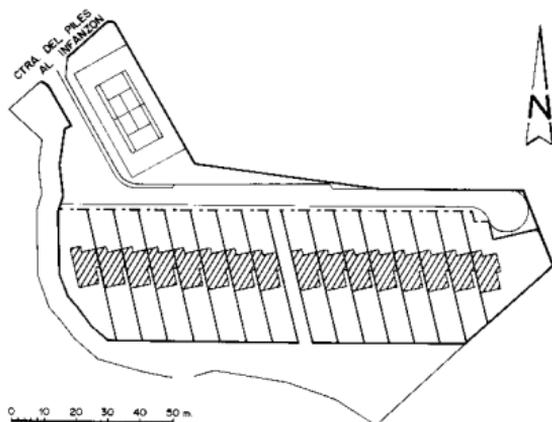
Planta de la colonia "Parque-Somío" en la era del Piles. 1987.
